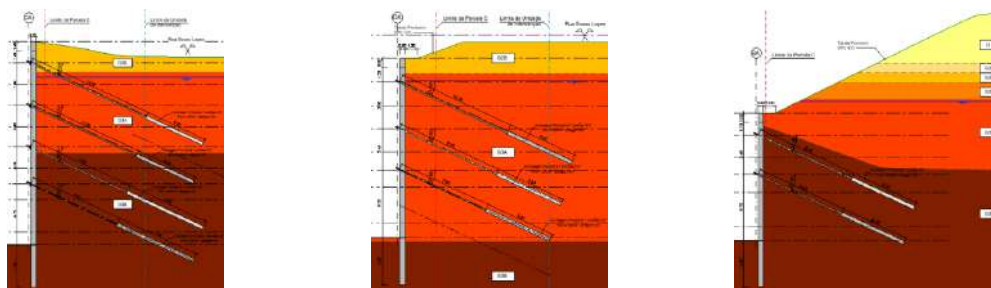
Estrutura de contenção do tipo parede moldada: Secções Tipo
